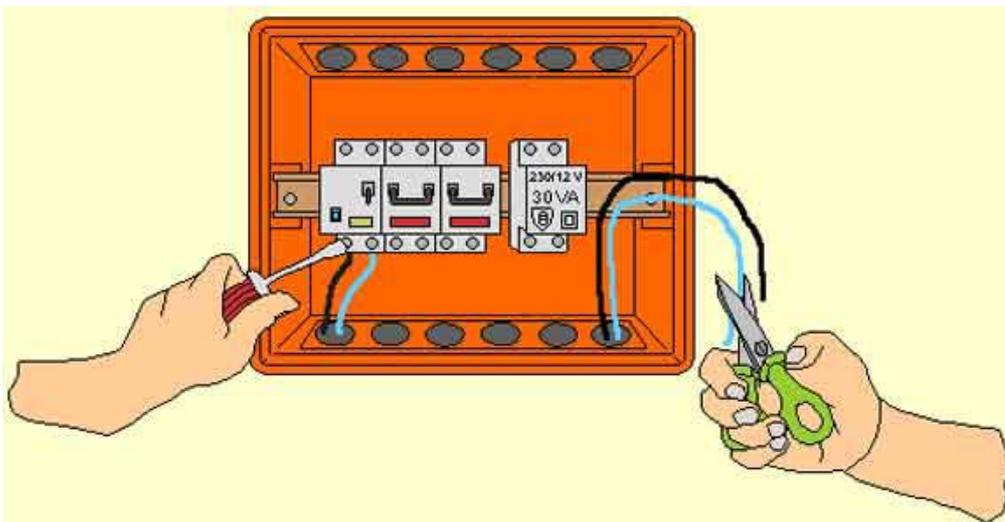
Collegamento e montaggio degli apparecchi sui supporti e fissaggio della placca di finitura
